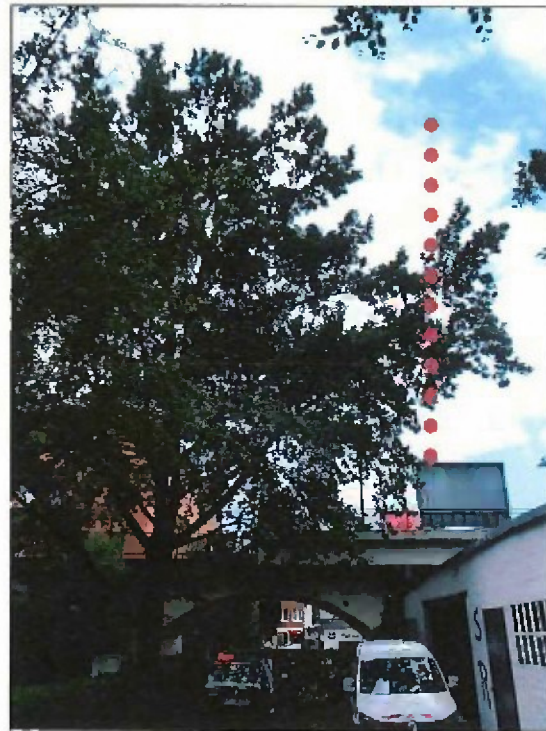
Baum-Nr. 19 mit markiertem Bereich für Kronenrückschnitt (Arbeitsraumprofil)
